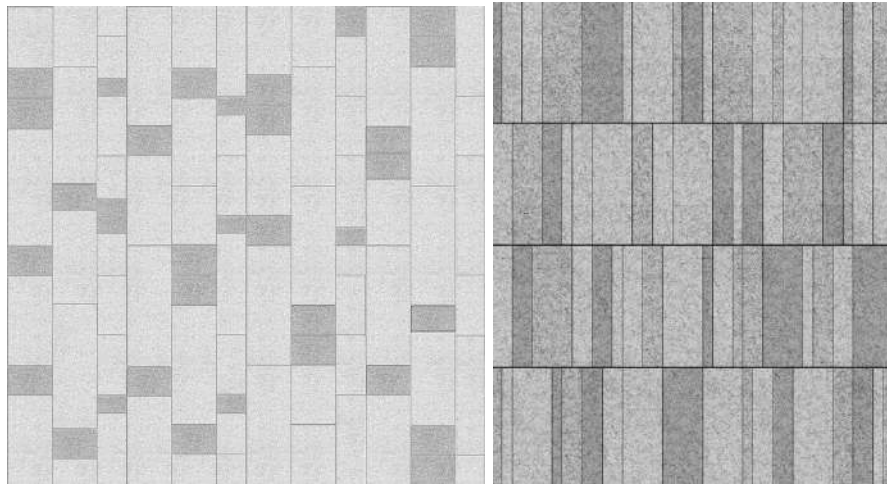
TIPOS DE ACABADOS DE PISO CONCRETO
